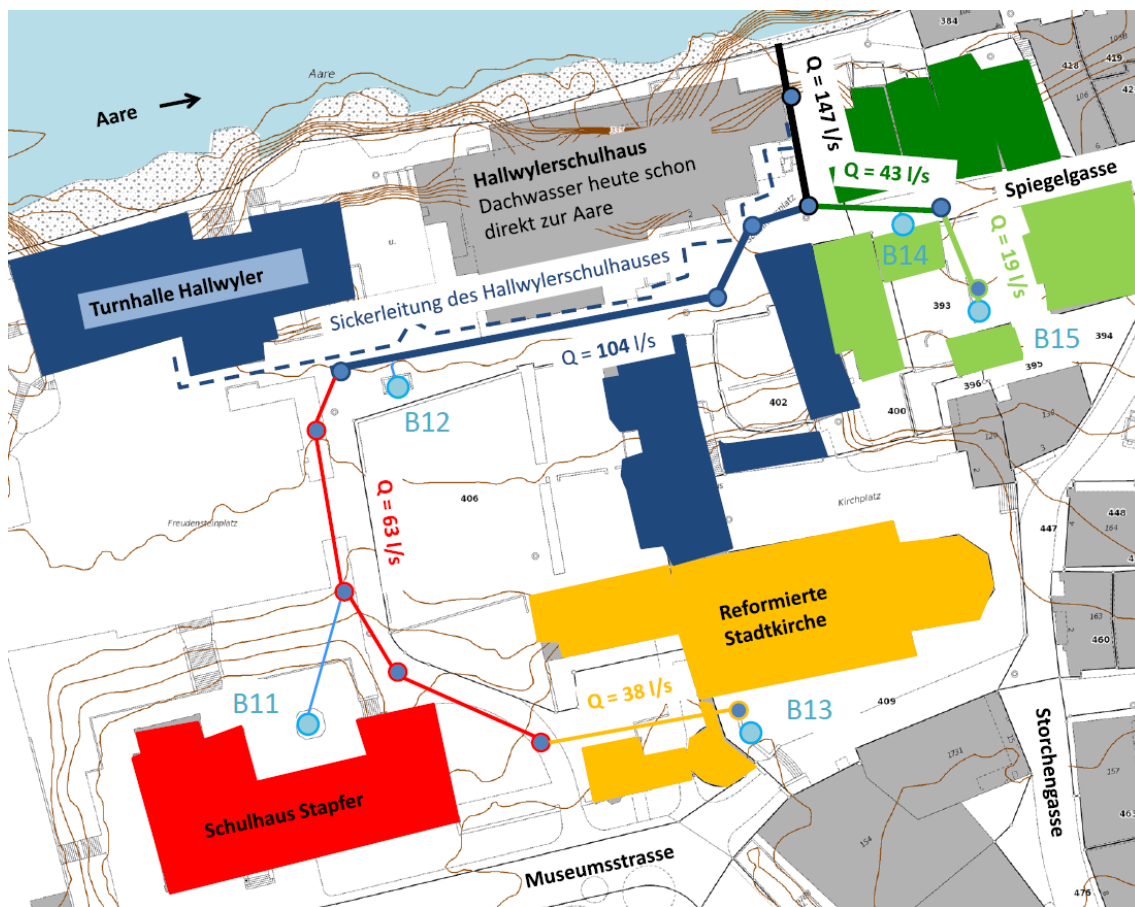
Angeschlossene Dachflächen und Sickerleitungen mit entsprechenden Wassermengen
